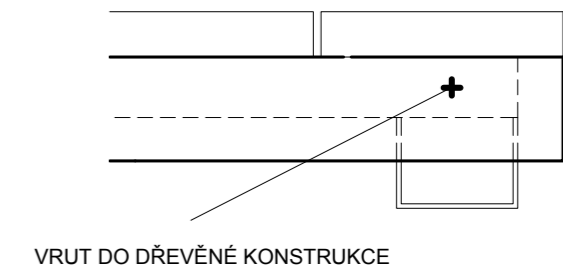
DETAIL UKOTVENÍ PRKEN NA DŘEVĚNÁ KONSTRUKČNÍ PRKNA M 1:5
